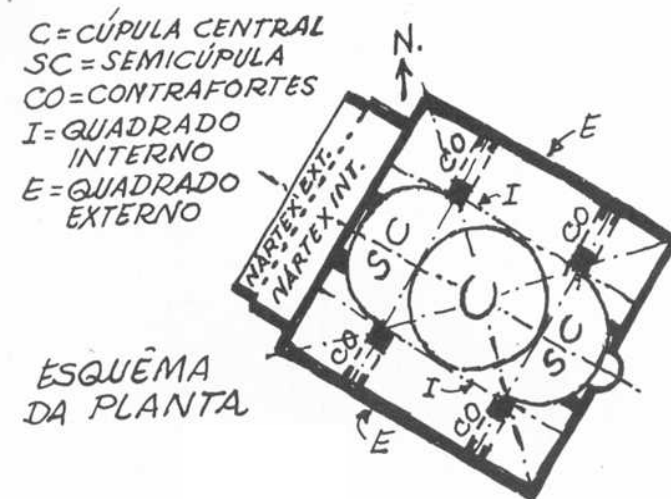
Planta esquemática do salão quadrado central da Igreja de Santa Sofia
